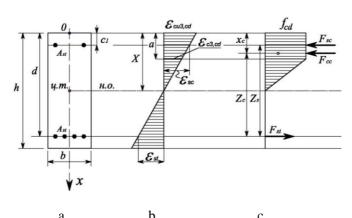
Схемы распределения относительных деформаций и усилий при расчете прямоугольного сечения с двойным армированием:
